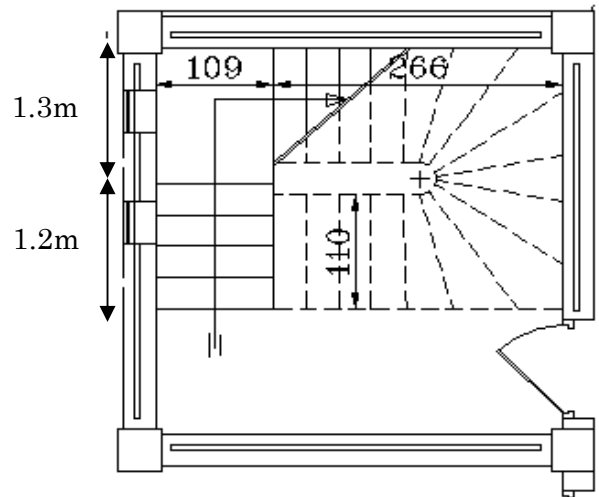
vue en plan de l'escalier balancé au niveau RDC
